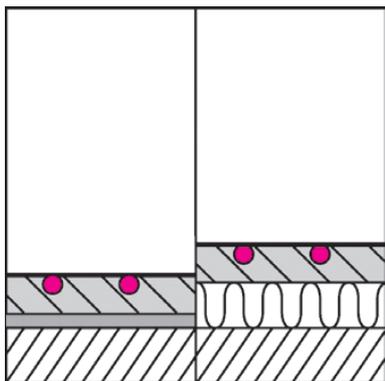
Bodenkonstruktion TB2 mit Trockenestrichplatten (TE)
